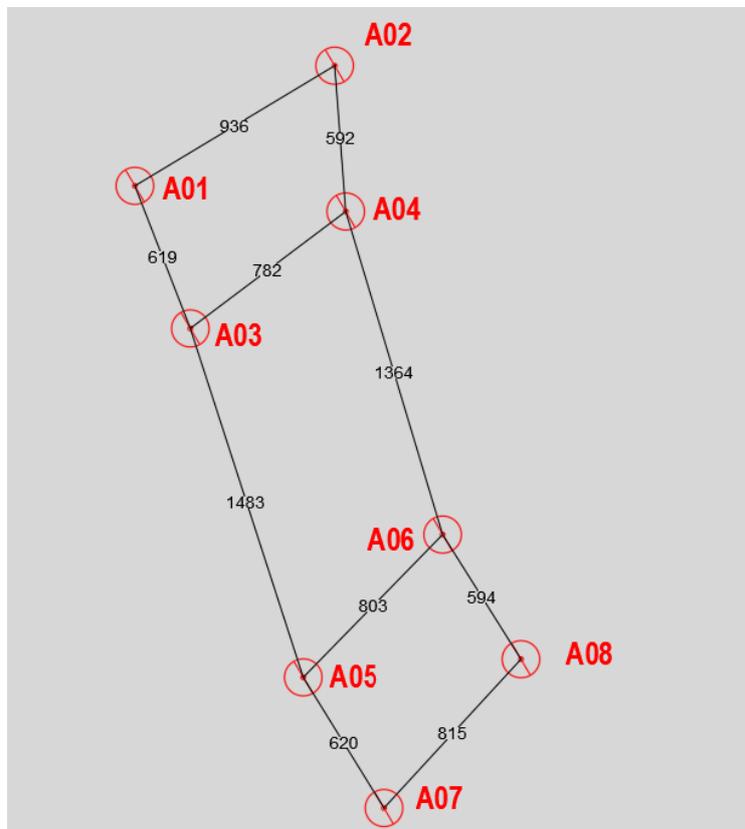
Schema layout con indicazione delle interdistanze tra le tribune di progetto
